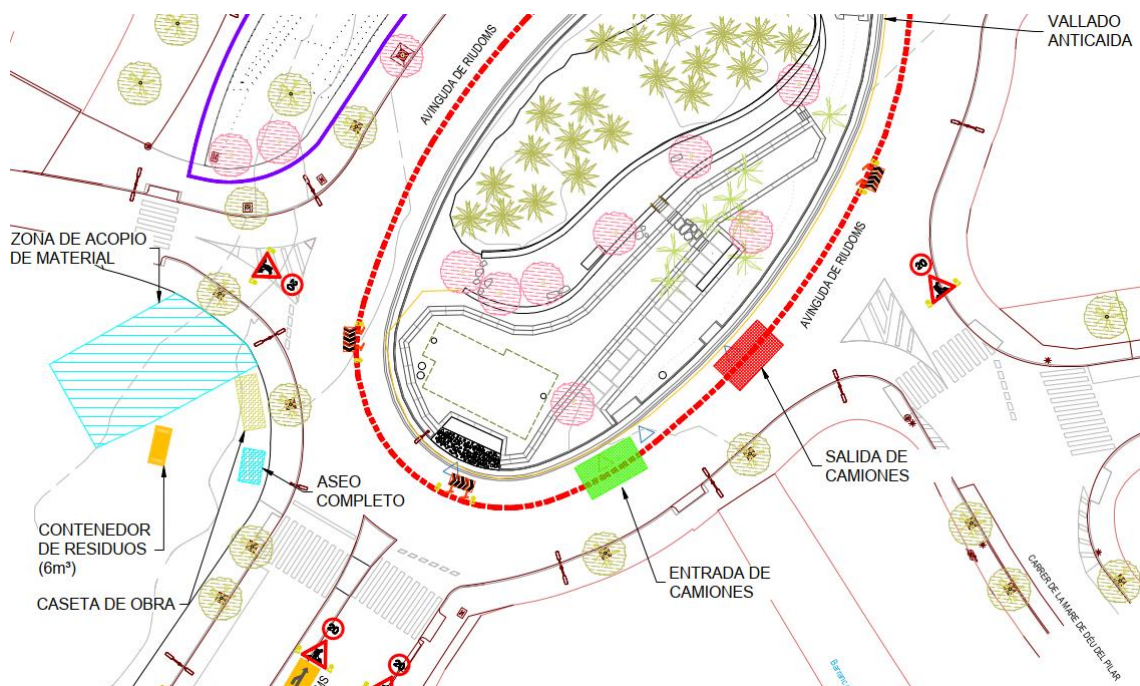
Detalle del plano WT1921-GB-F2-DR-WT-14-SeguridadySalud.
